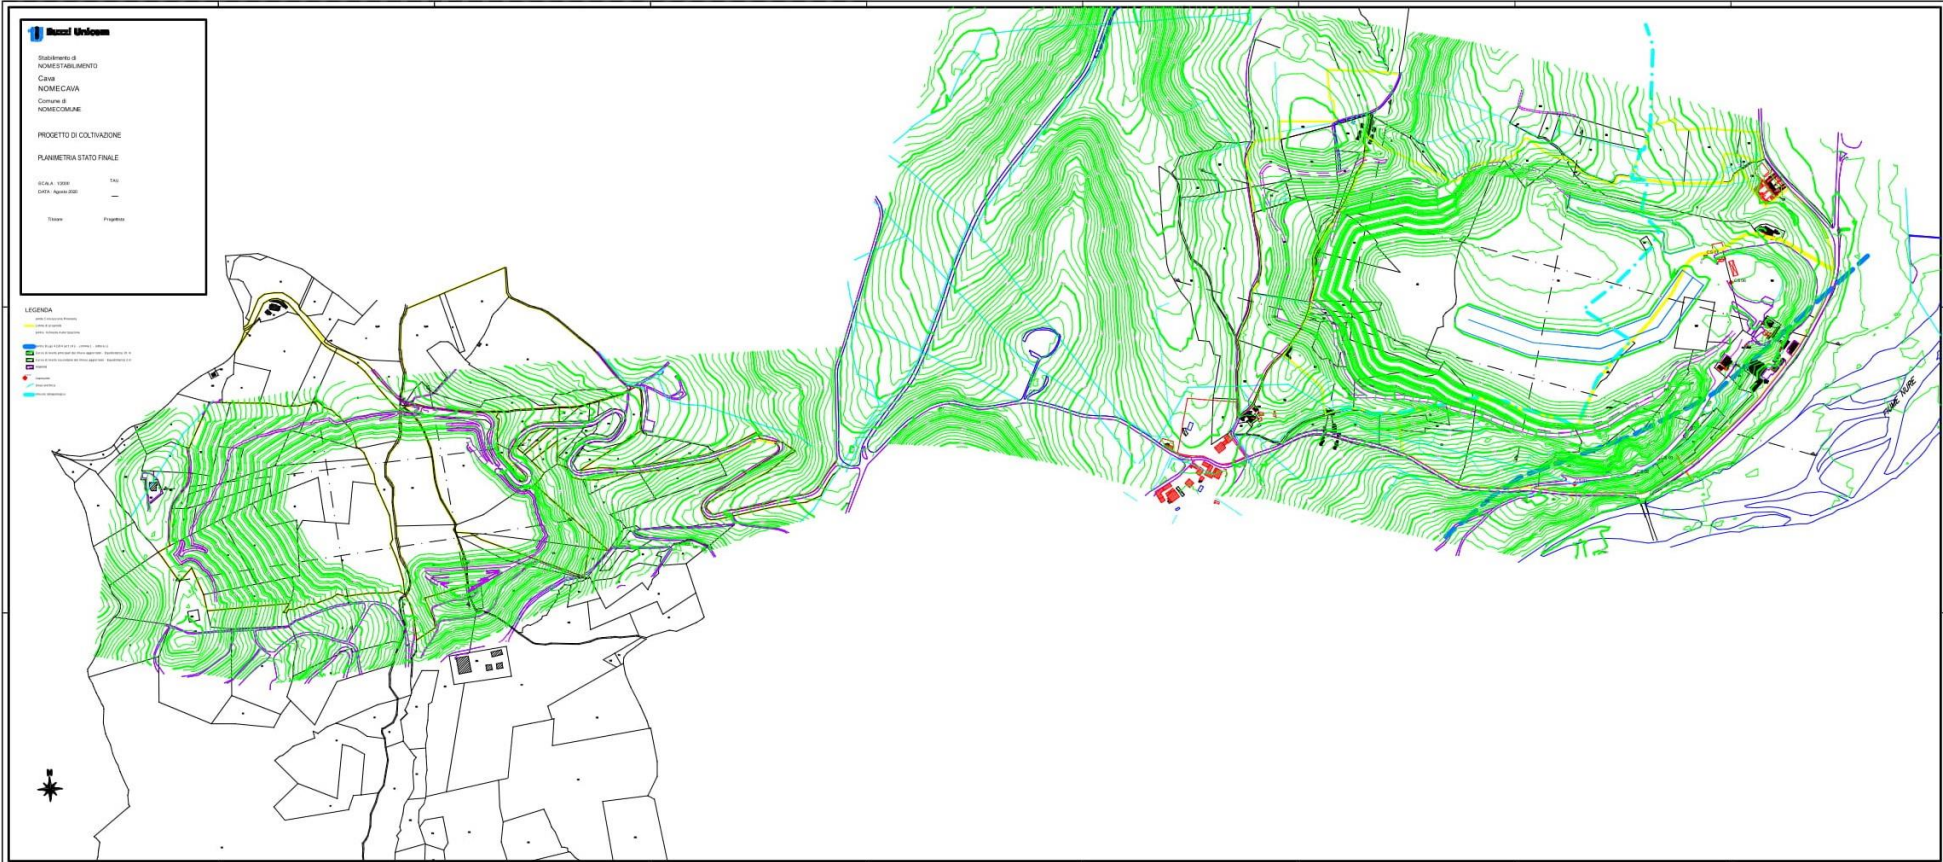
Planimetria di progetto - Fase 4 (20 anni)
